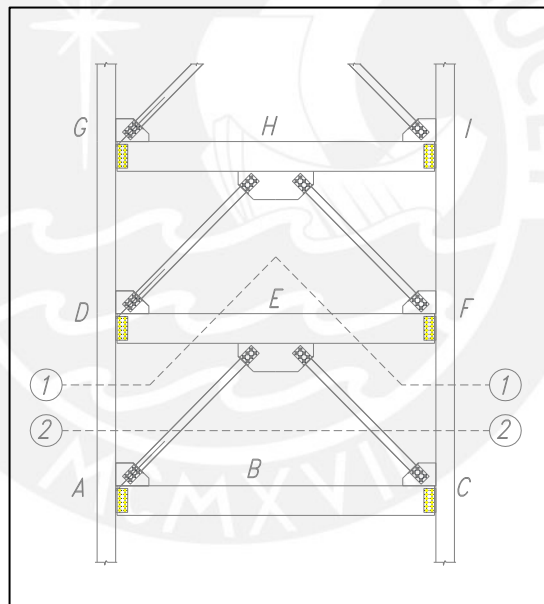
Vista de Pórticos con Arriostres sin Columnas Zipper
